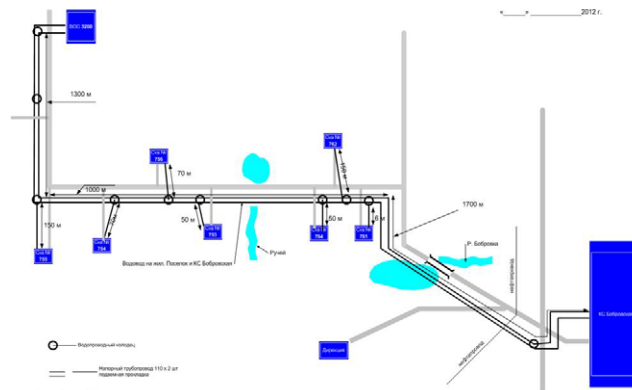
Схема прокладки внеплощадочных сетей водопровода
